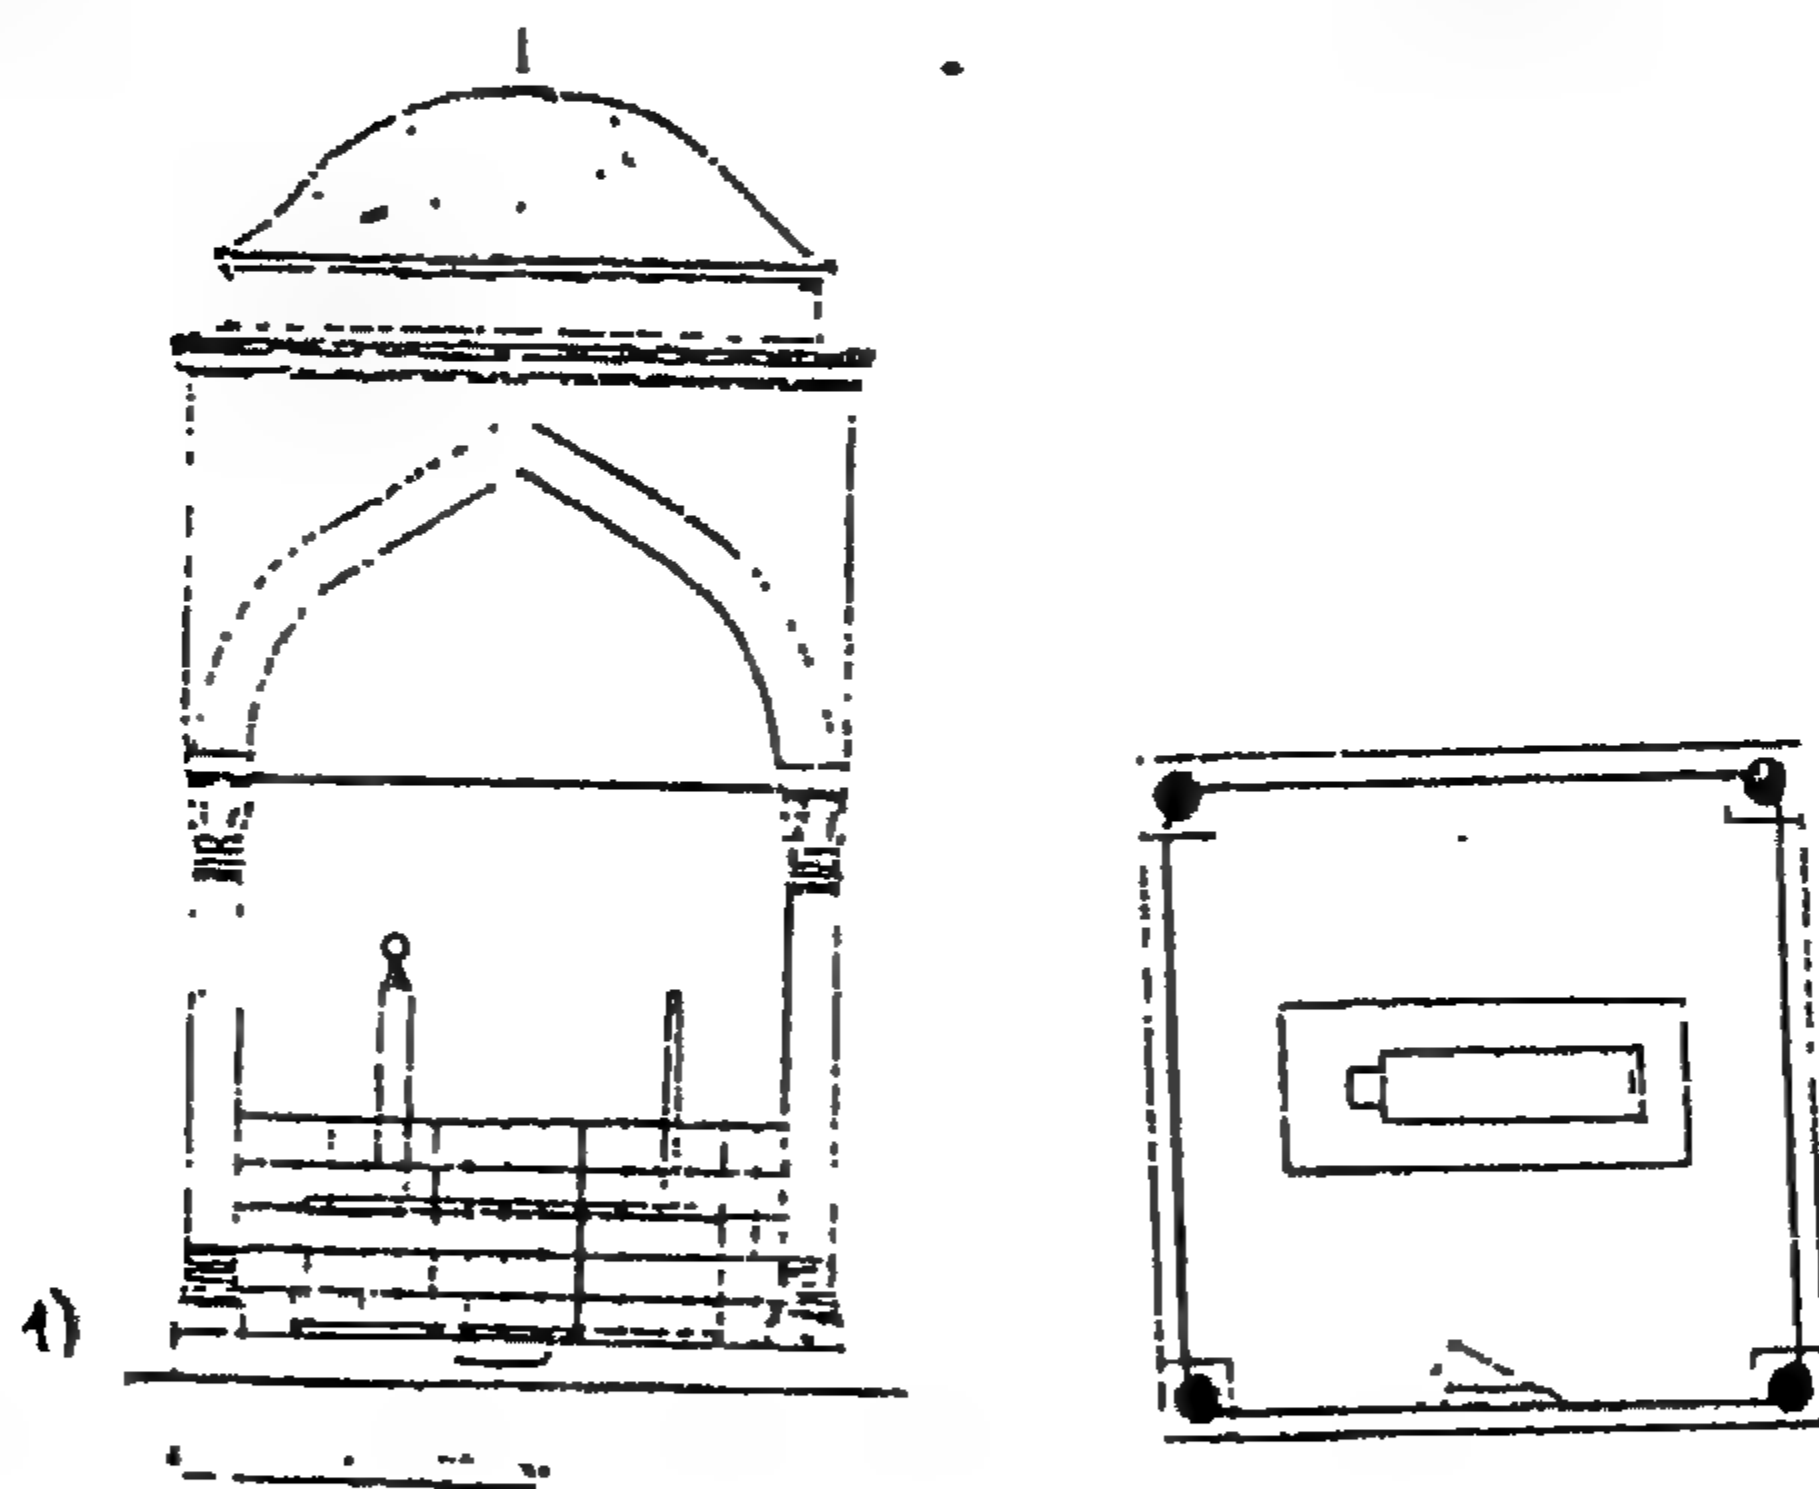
مسقط أفقي لتربة شاهزاده محمد باستانبول (عن : اصلان ابا) .
